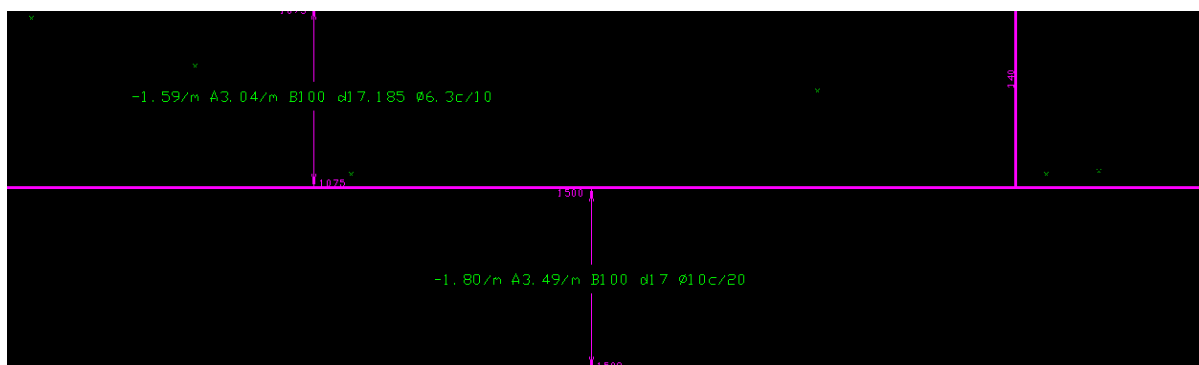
Faixas de distribuição de armaduras homogeneizadas
